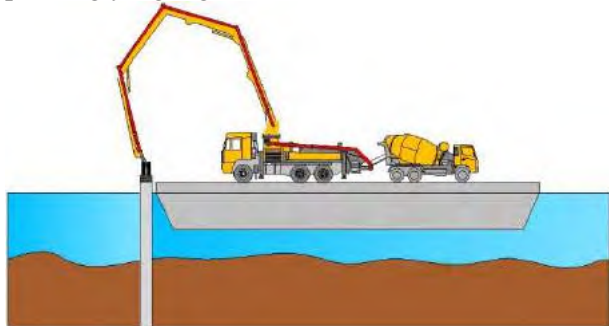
Pendistribusian concrete mixer dan concrete pump
